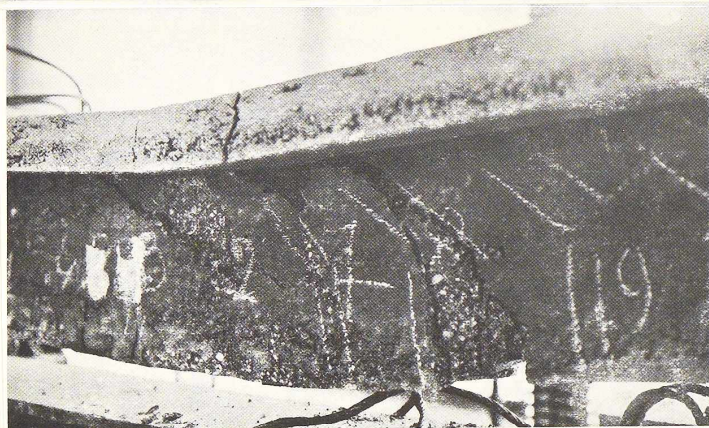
Aspect des ruptures d'effort tranchant et de glissement de la poutrelle, dans le cas d'un enrobage en béton de bims; l'aile supérieure de la poutrelle n'atteignant pas le dessous de la semelle.
